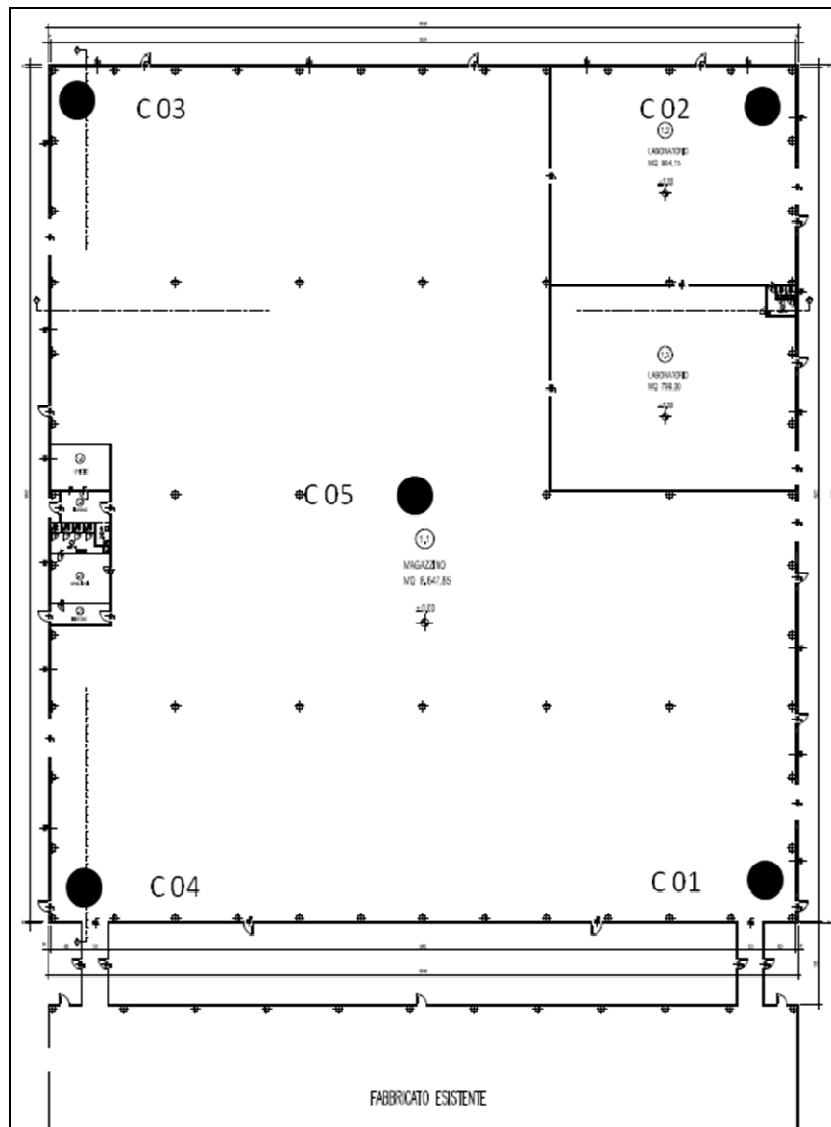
Pianta dell'edificio in progetto con ubicazione dei campioni di terreno
